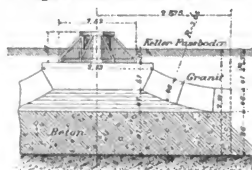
Gründung der Säulenreihe im Worldgebäude in New York. M. 1:100.
